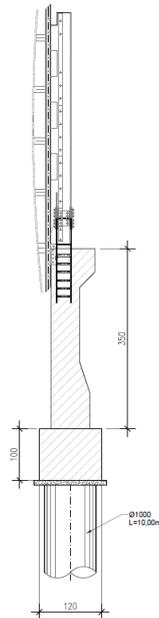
Muro in c.a. su fondazioni profonde – Sezione
